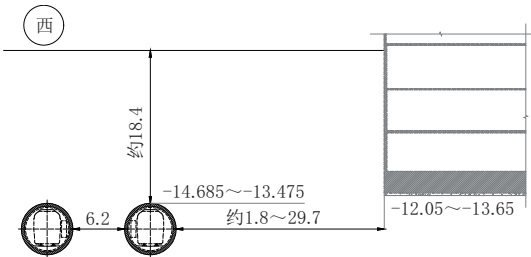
基坑与地铁相对位置关系剖面图(单位:m)
